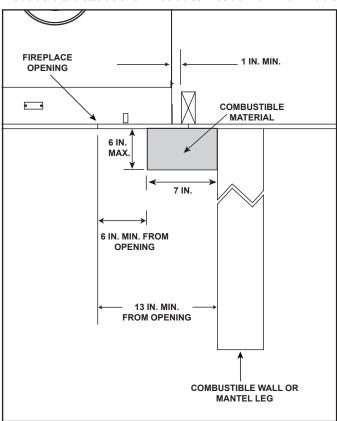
Dégagements par rapport aux pieds de la tablette de cheminée ou saillies du mur inflammable.
